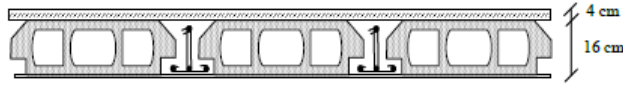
Coupe transversale du plancher à cors creux
